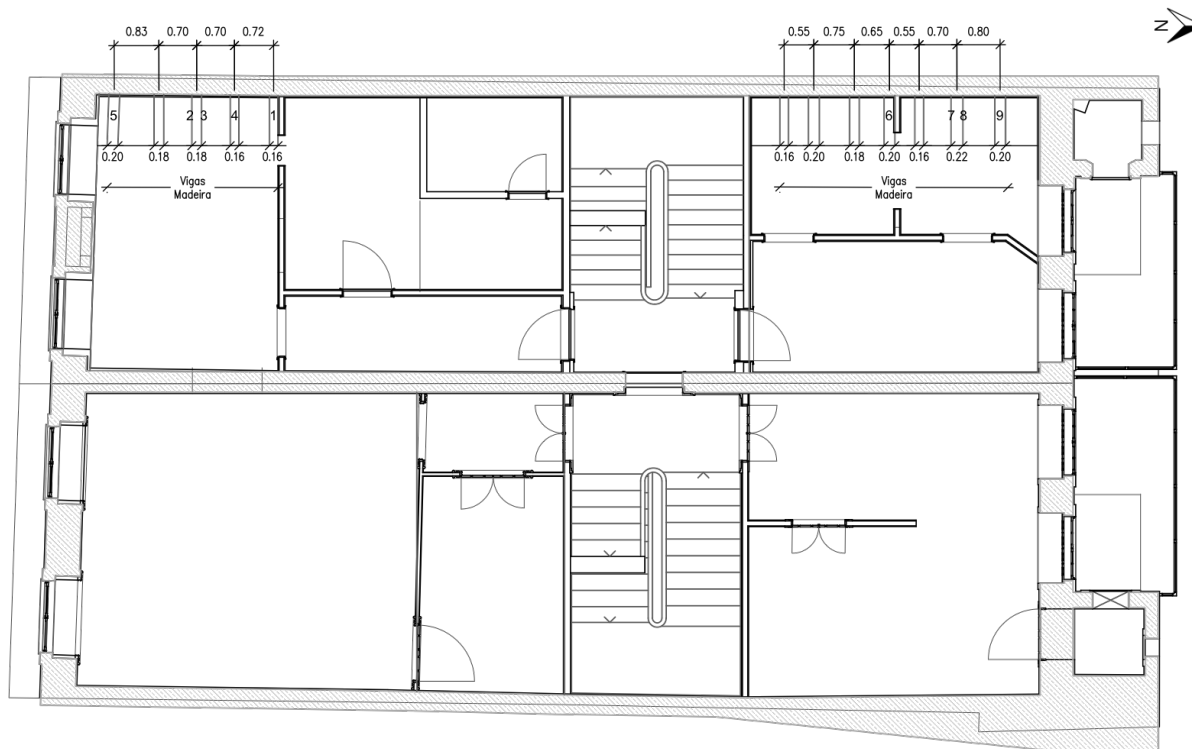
Planta do piso 1, com os ensaios numerados de 1 a 9.
